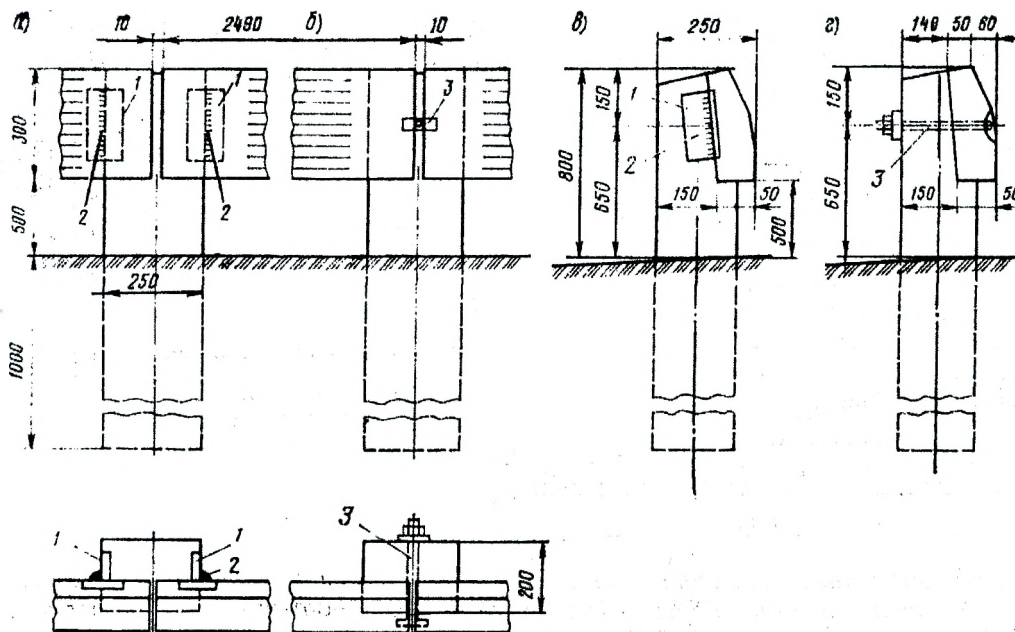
Железобетонное барьерное ограждение: а, в – соединение балок и стоек с помощью сварки; б, г – соединение с помощью стальных болтов; 1 – закладной элемент; 2 – сварной шов; 3 – болт
